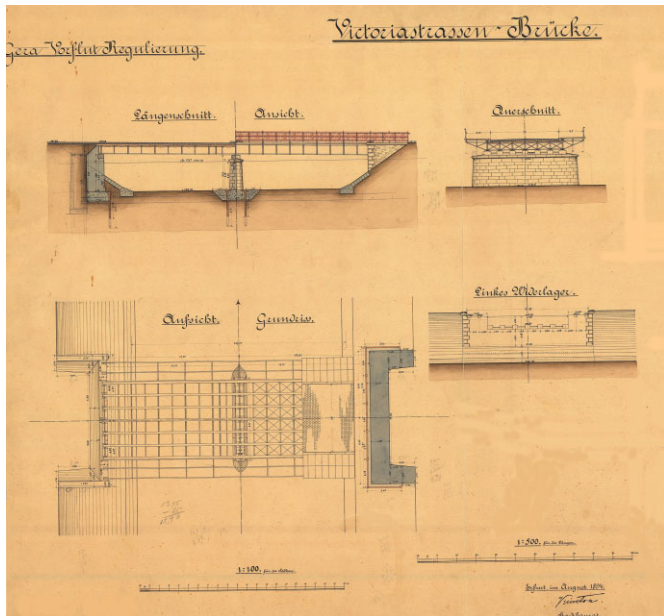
Viktoria Bridge – Bauwerksplan – HERMANN KICKTON – 1894
